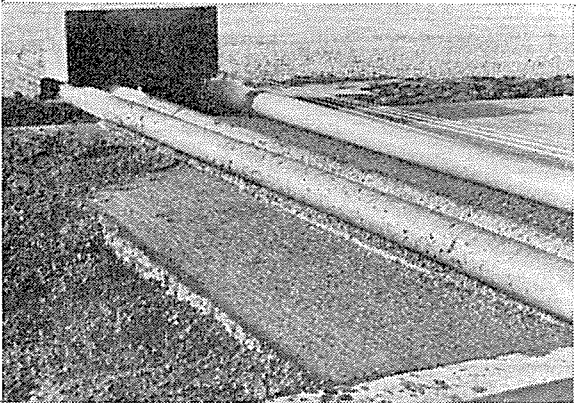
クラリアパワースクリードによるコンクリート舗設状況
